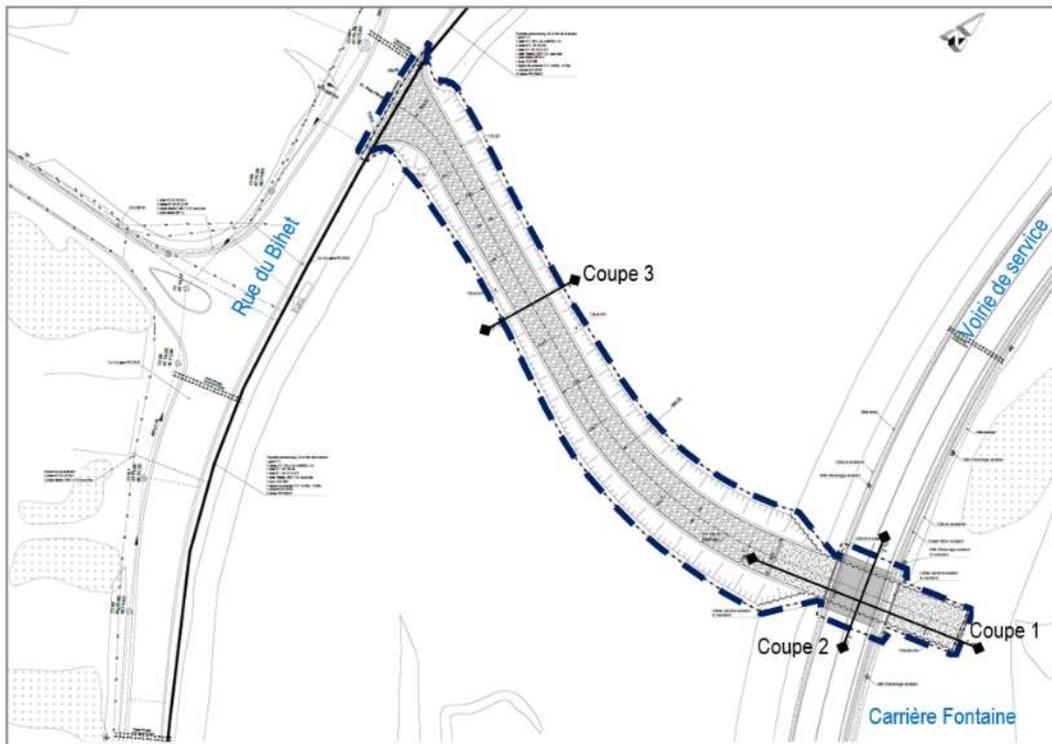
Plan d'implantation de la piste d'accès (zoom) (GREISCH, 2020)
